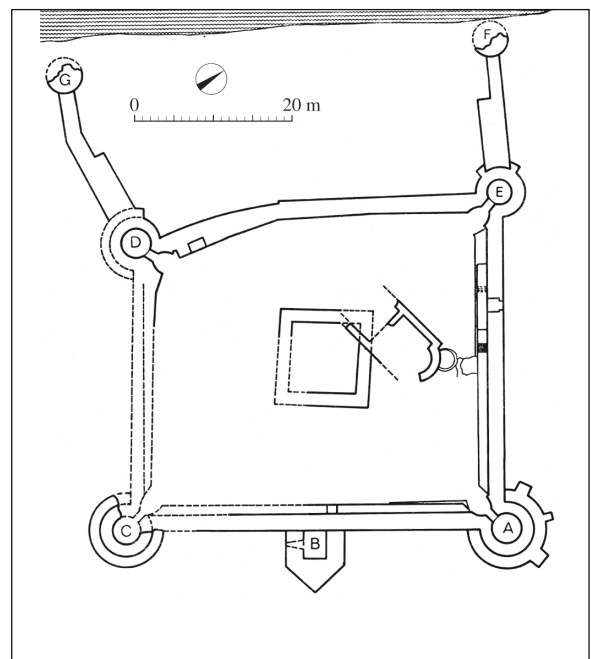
Hajdučka Vodenica. Grundriss (nach Jovanović 1982–1983, Abb. 1).
